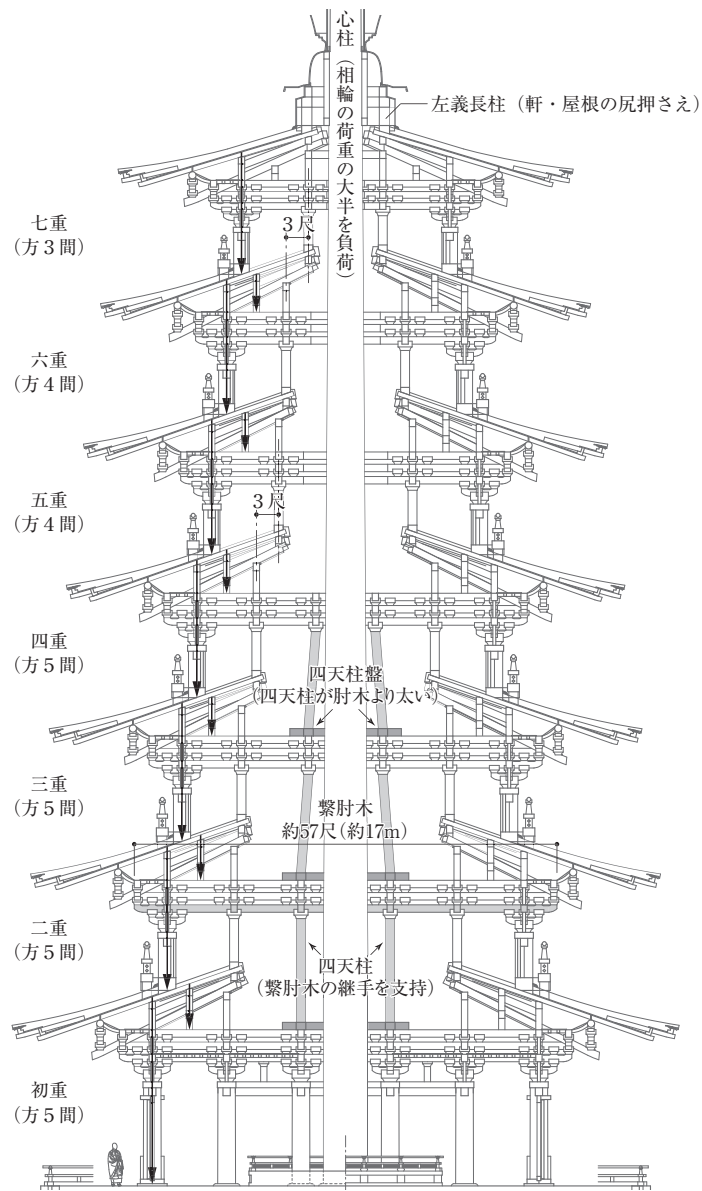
天平塔の組み上げ構造 (塔身断面図) 1 : 300
